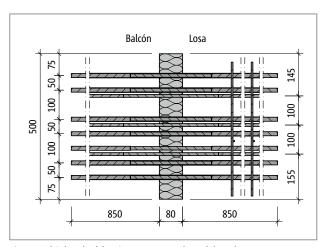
Schöck Isokorb® T tipo K-M13-V1: Plano del producto
